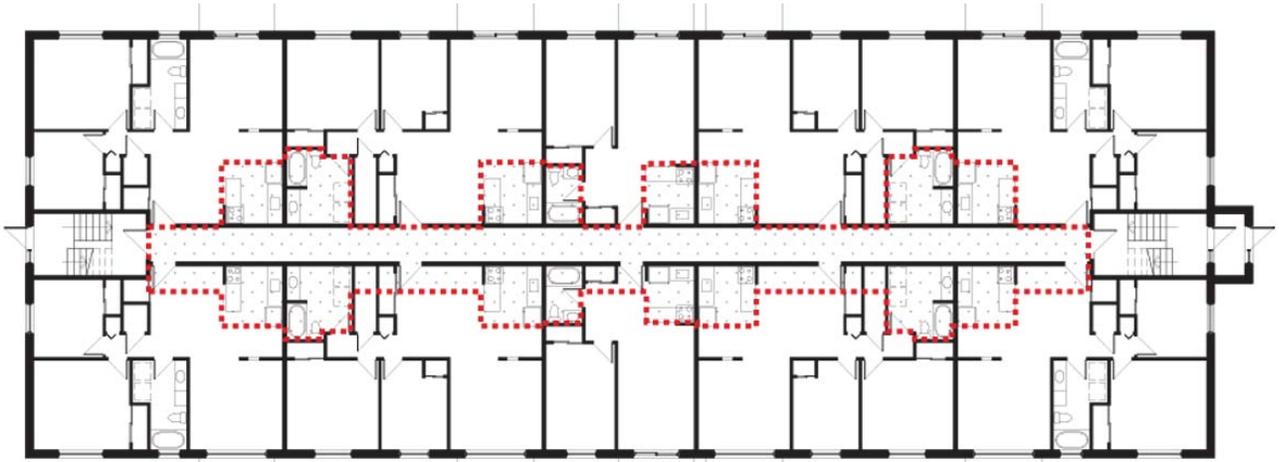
RESTRUCTURATION DU PLAN EXISTANT
